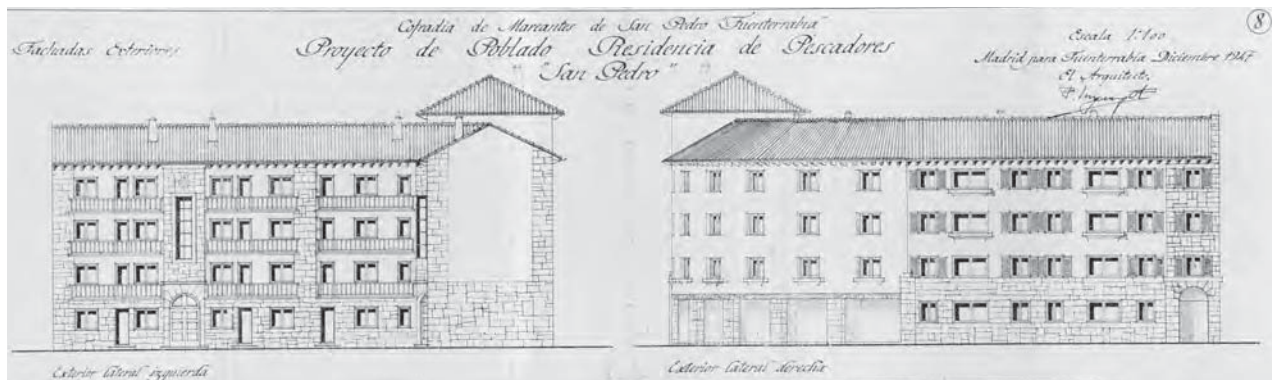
Pedro Muguruza, fachadas exteriores, plano n.º 8. Fotografía: Proyecto de Poblado. Residencia de Pescadores San Pedro, 1947, Archivo Municipal de Hondarribia, sig. U-214-II-11002, plano 8.
